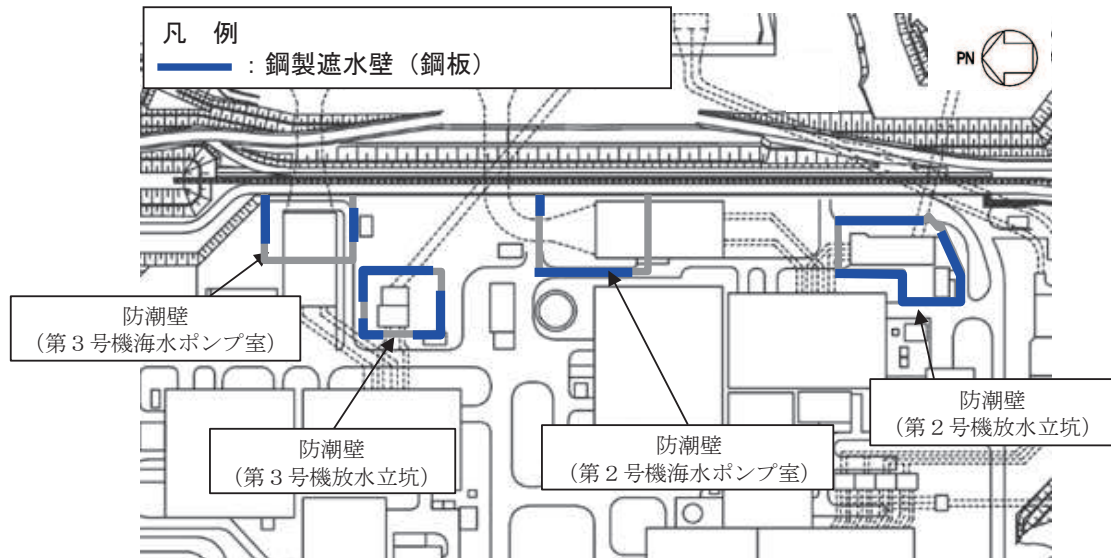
鋼製遮水壁（鋼板）の平面配置図
